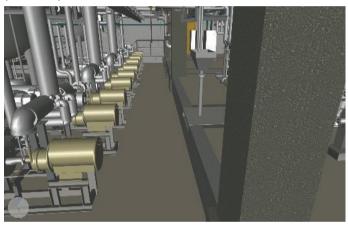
Exemple de livrable bon pour construction – Second œuvre d'une salle blanche – Extrait de la maquette architecture (© Jacobs).
